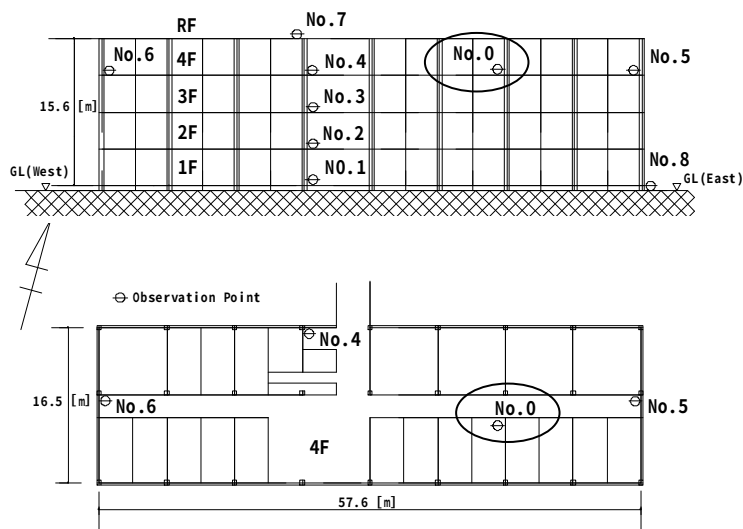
観測対象建物 (上) 断面図 (下) 4F 平面図
